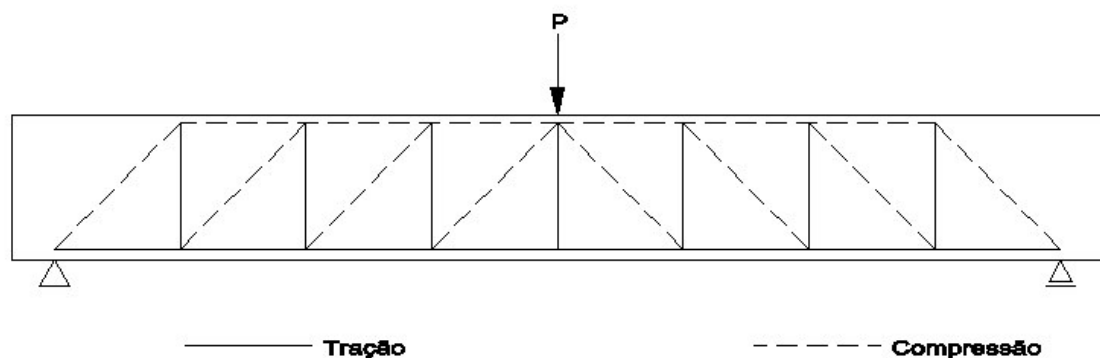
Modelo de treliça para uma viga (Silva e Giongo, 2000)
